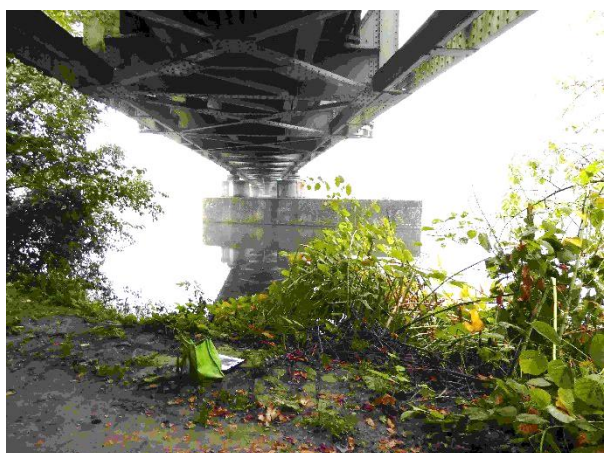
Ufer unter der Brücke mit geringem Bewuchs ...
